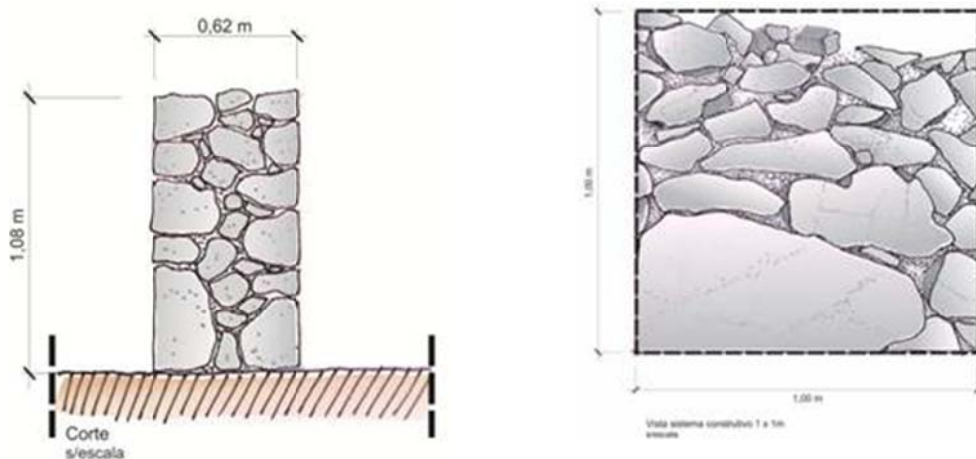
Corte transversal e detalhe do muro com alvenaria de rocha e junta seca, elaborado a partir da estrutura identificada na zona rural de Pesqueira, PE.
